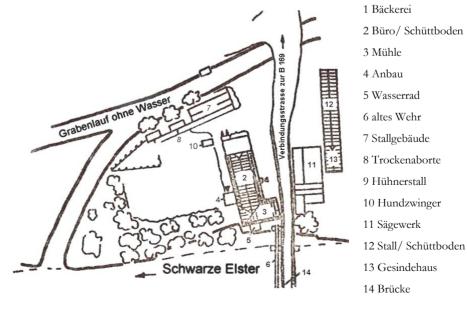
Skizze Elstermühle Plessa. Quelle: OnkelJohn (2007).
